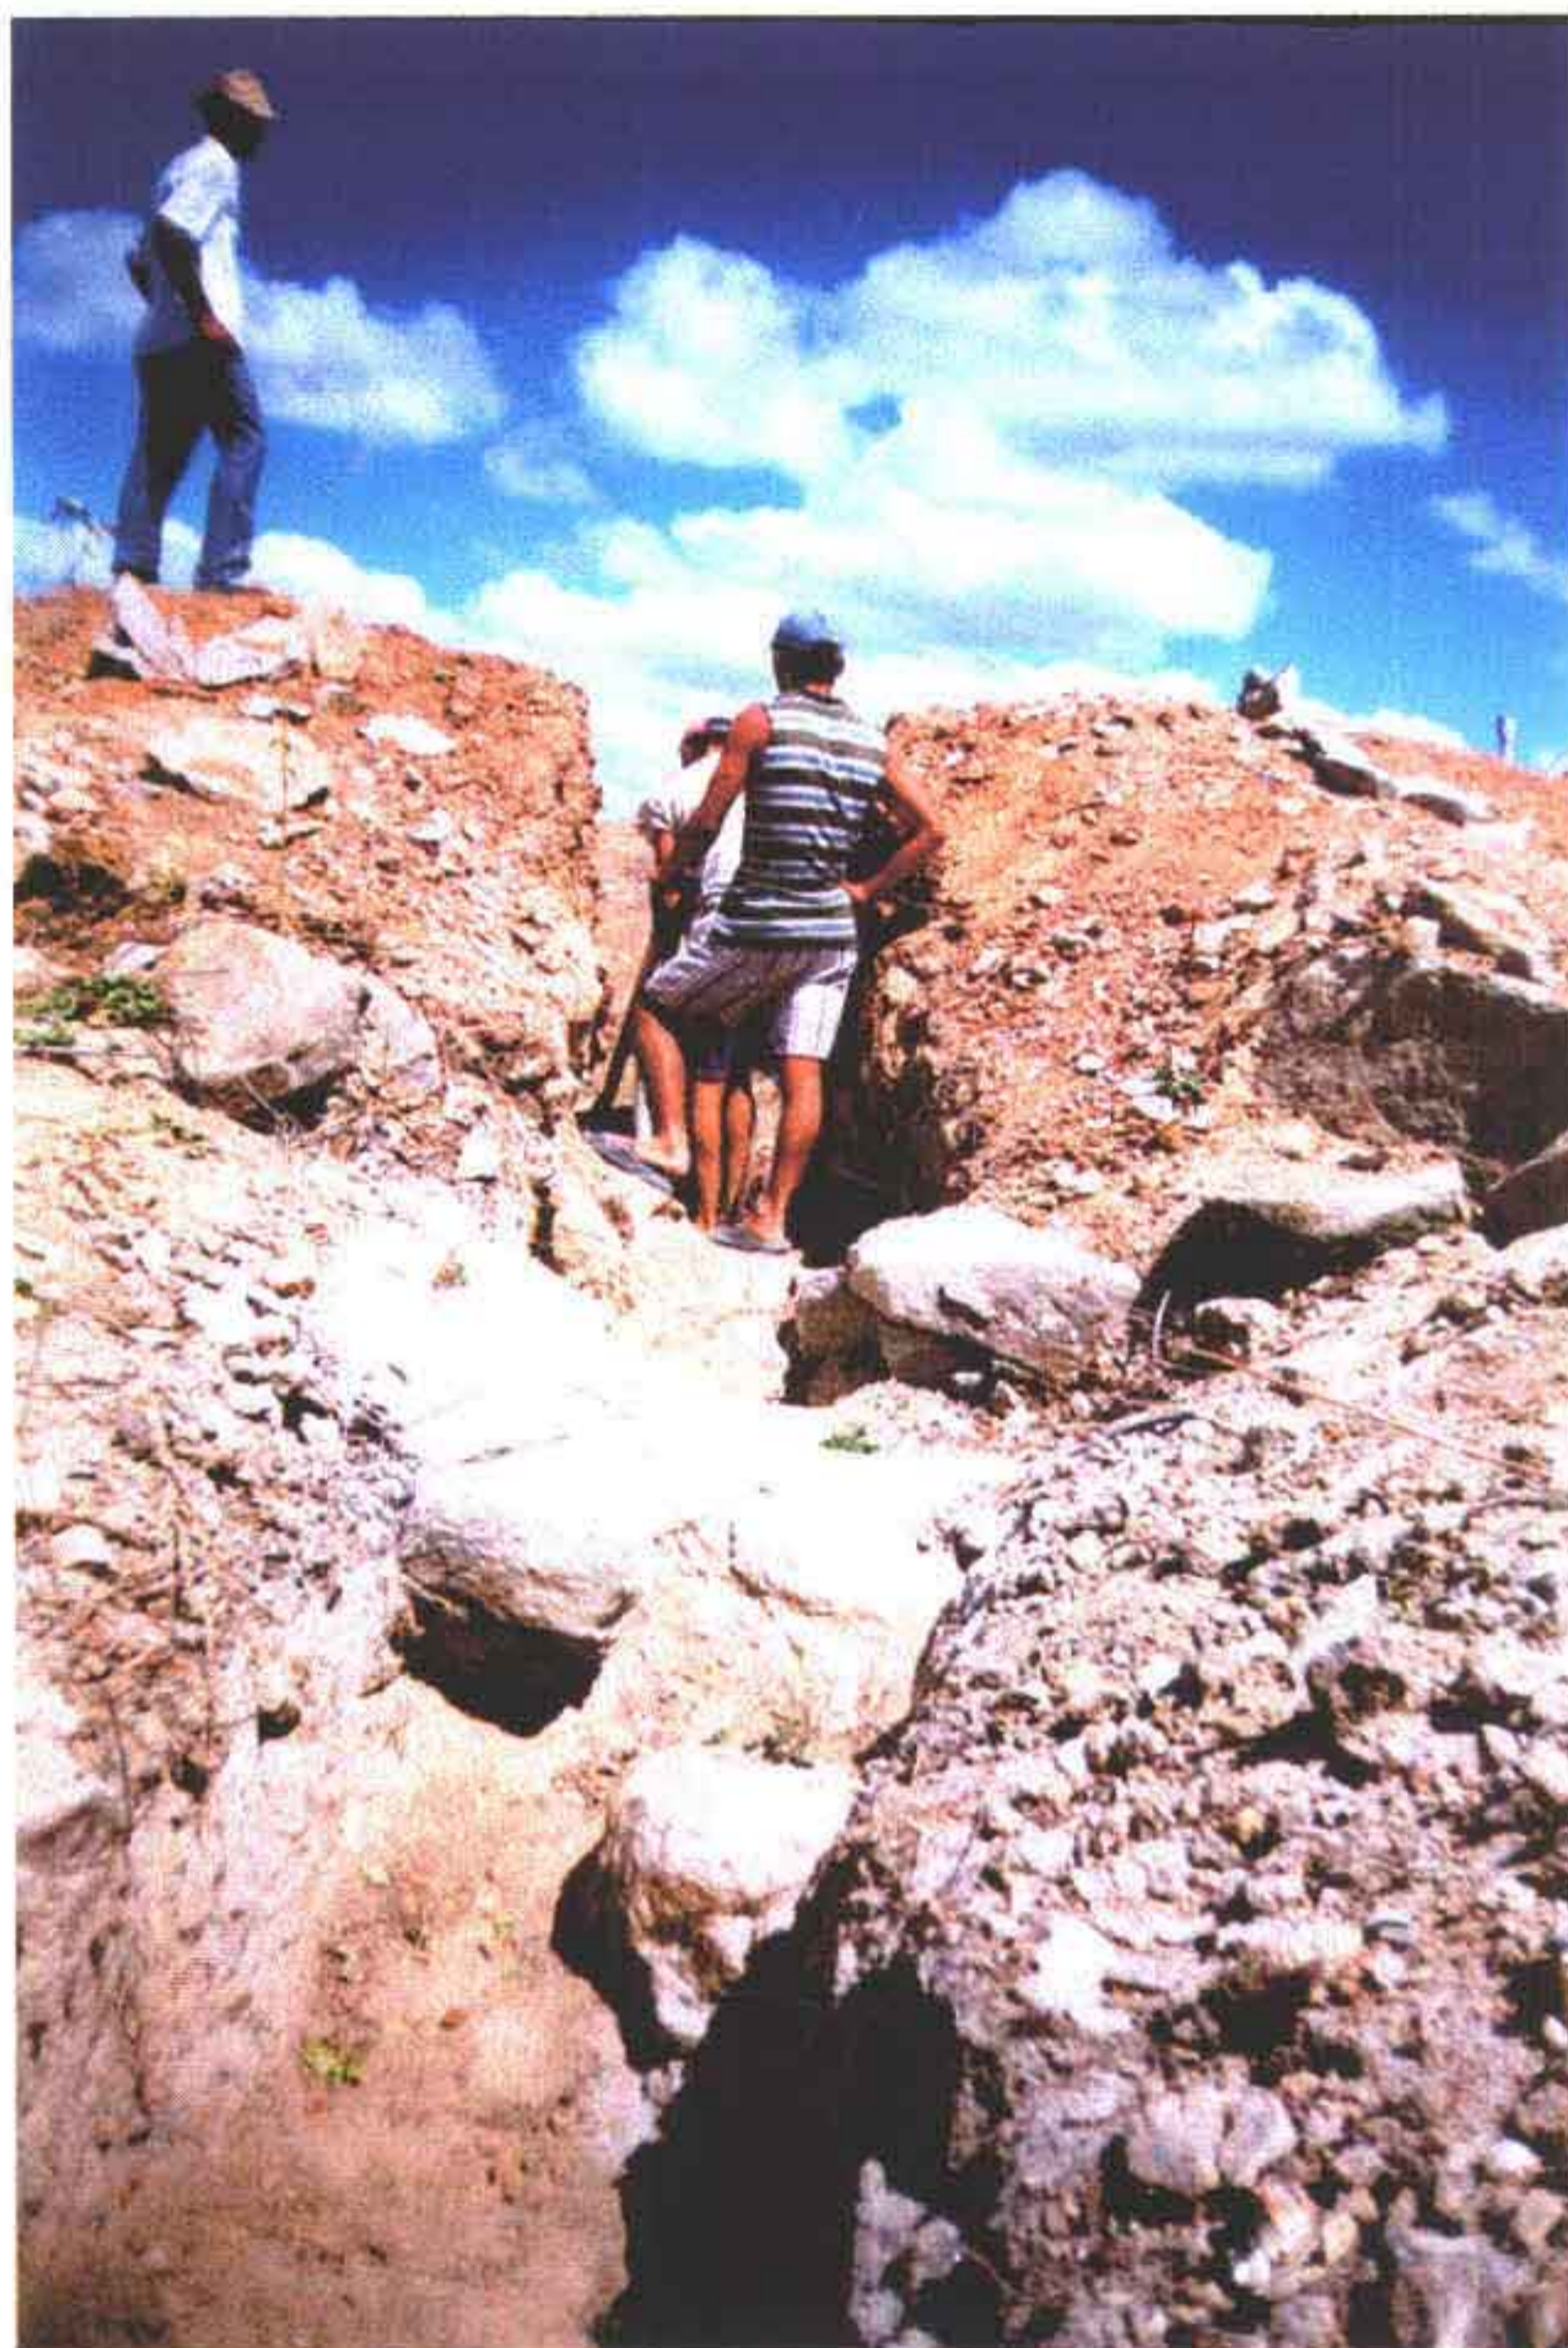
Escavação em rocha na entrada da cidade de Piquet Carneiro.
